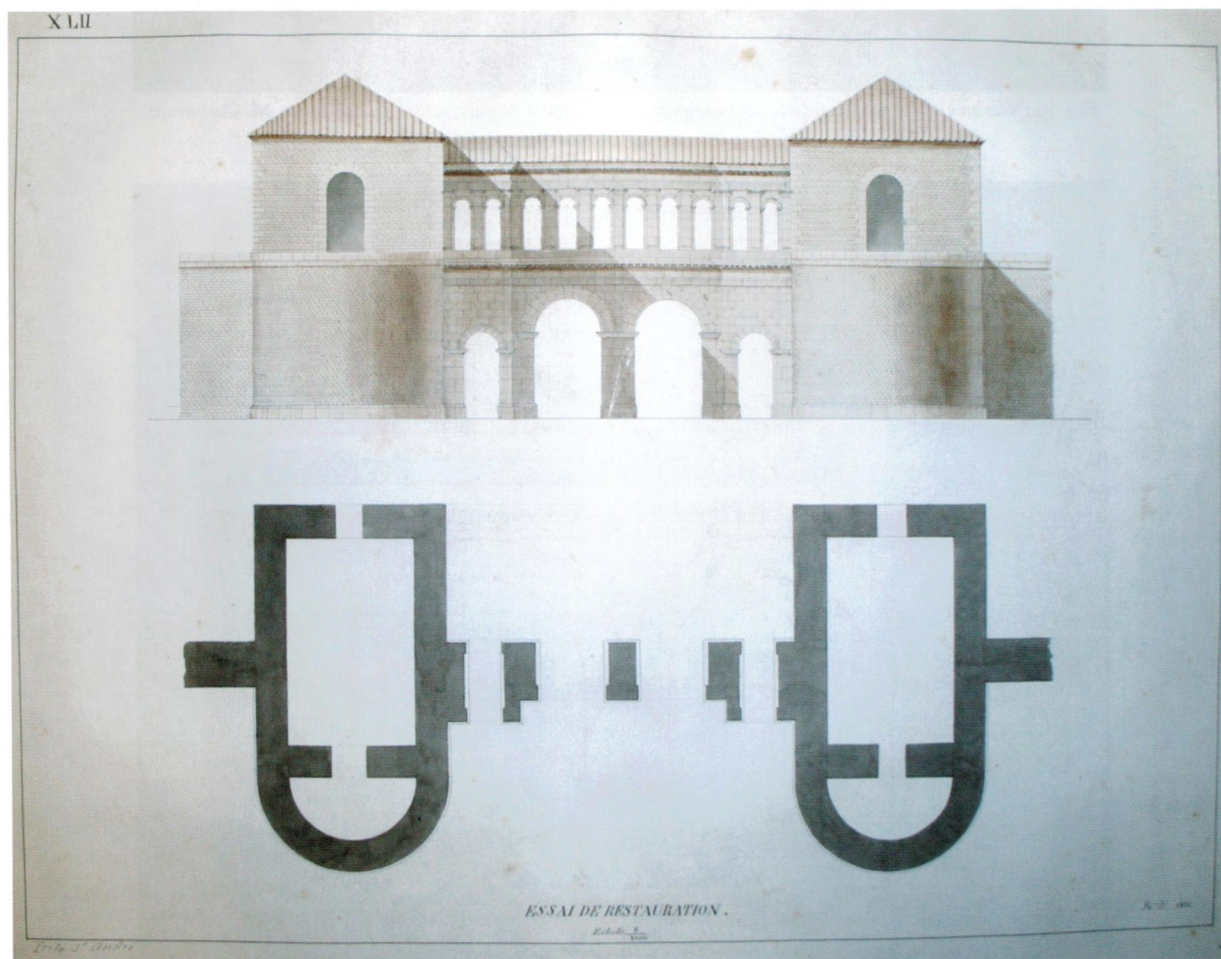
Planche réalisée par Roidot-Errard. Restitution en élévation et en plan de la porte d'Arroux.
